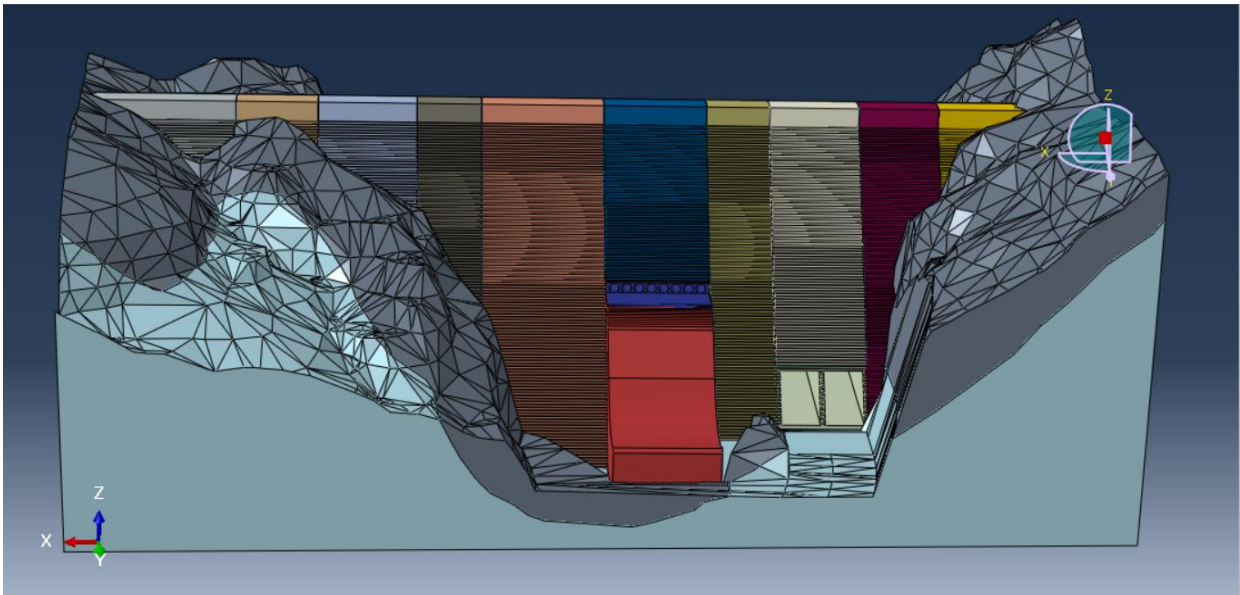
Geometría tridimensional de la cortina de la presa Pilares en la etapa final de construcción, en la elevación 231.23 msnm.
